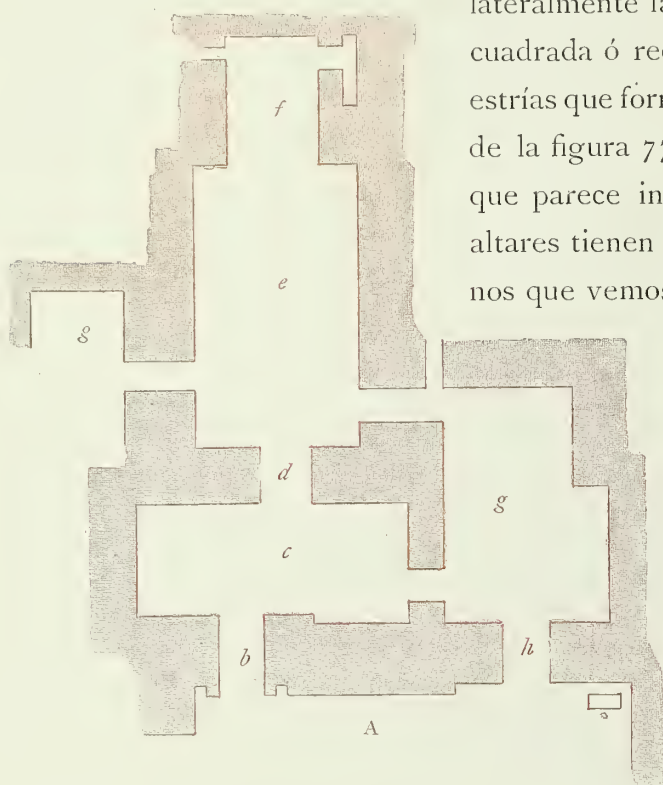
PLANTA DE UN TEMPLO MENOR EN NIMRUD (CALACH)
